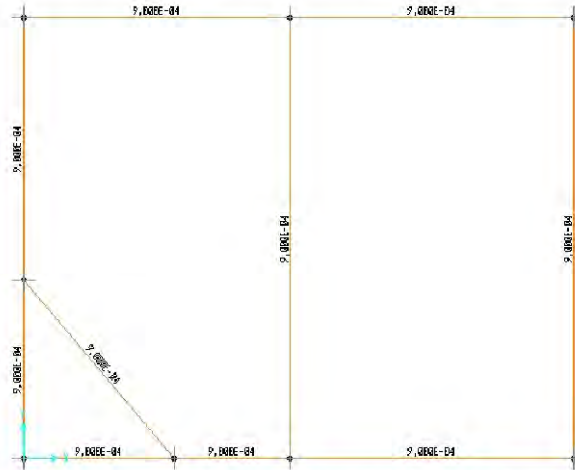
Refuerzos longitudinales en vigas – cubierta
